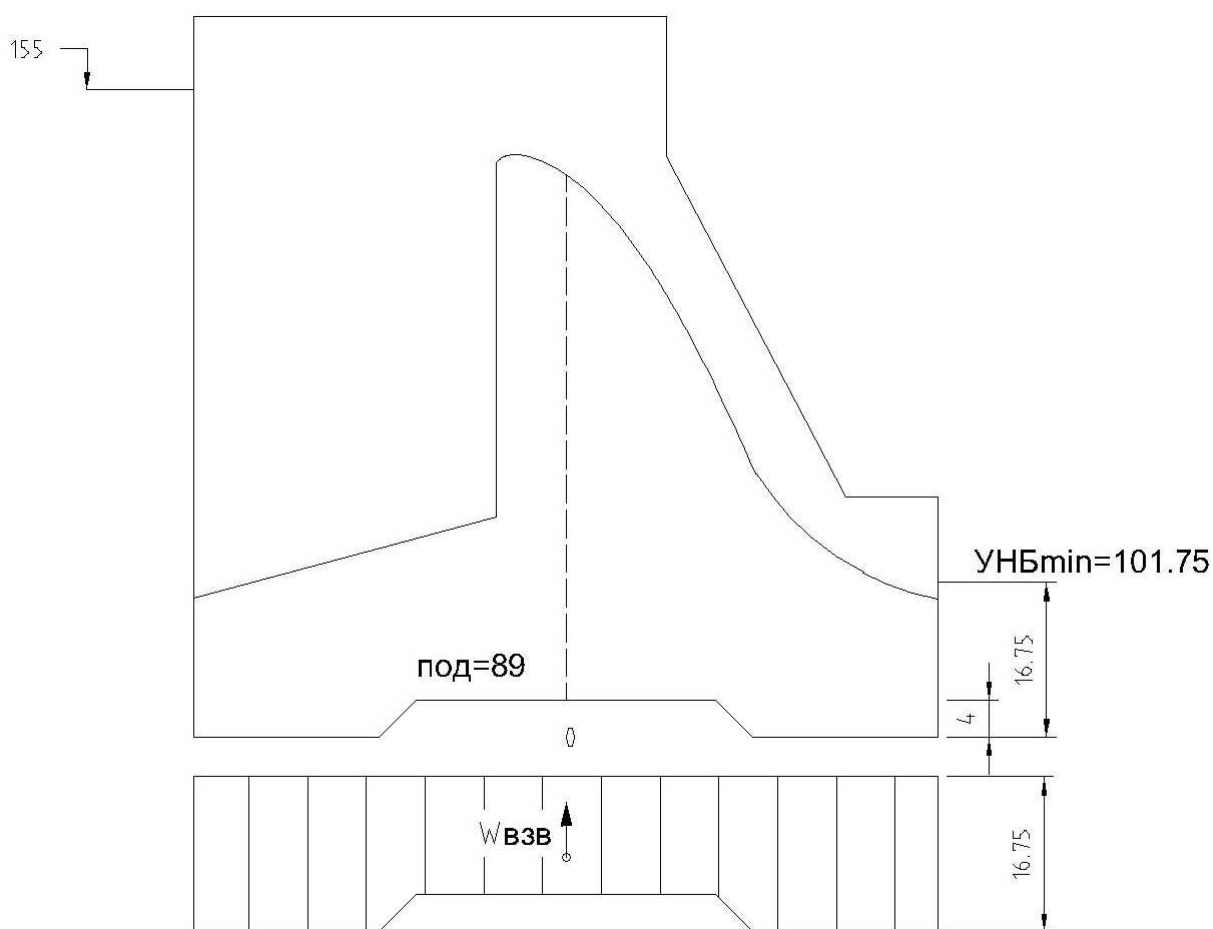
Эпюра взвешивающего давления на подошву для основного сочетания нагрузок
